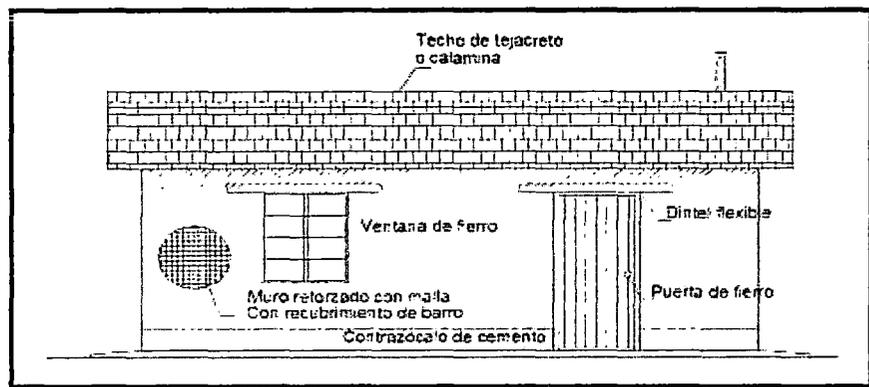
Elevación Frontal de una construcción de adobe terminada
